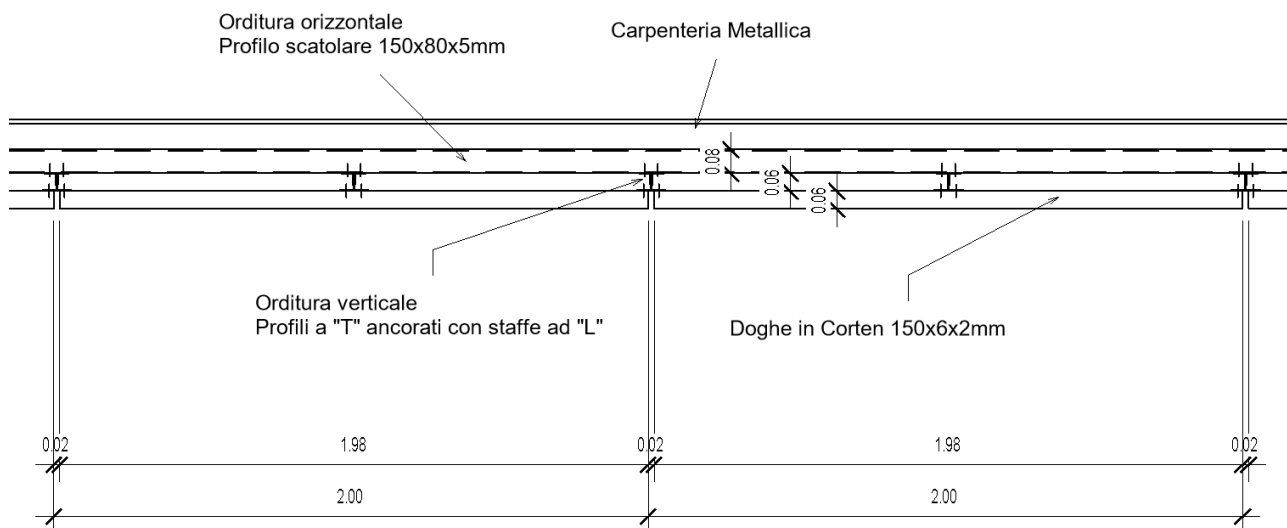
Dettaglio costruttivo dell'ancoraggio delle doghe alla struttura metallica – vista in pianta
